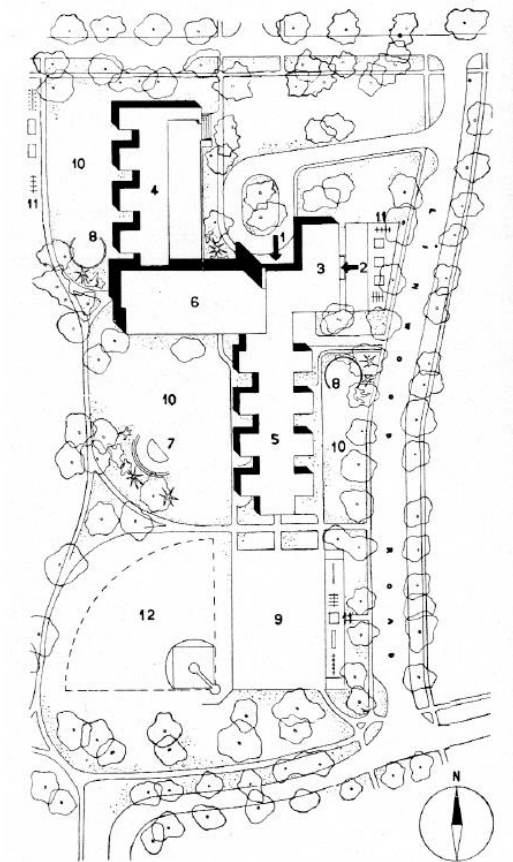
Planta de cubiertas del Crow Island School. (Roth 1950, 112)
